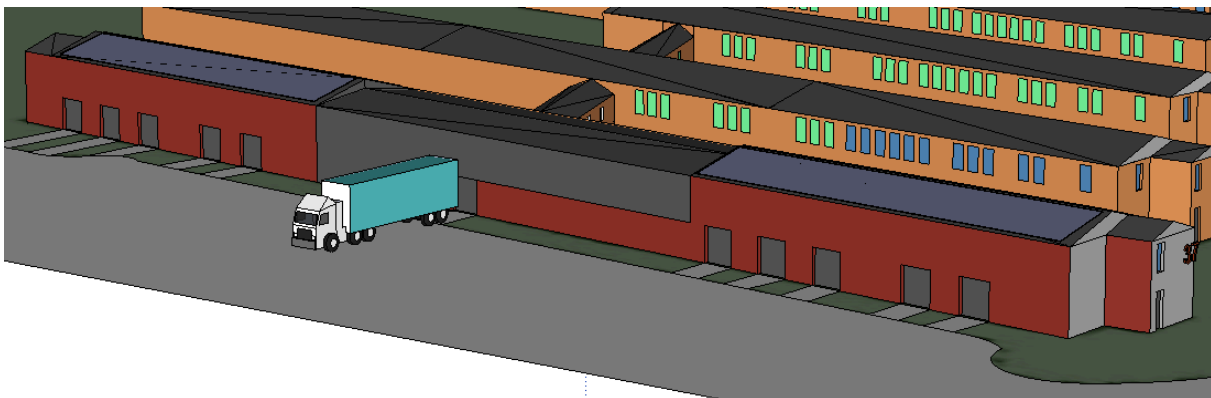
Illustration de l'installation des panneaux solaires sur les bâtiments de la zone Est
